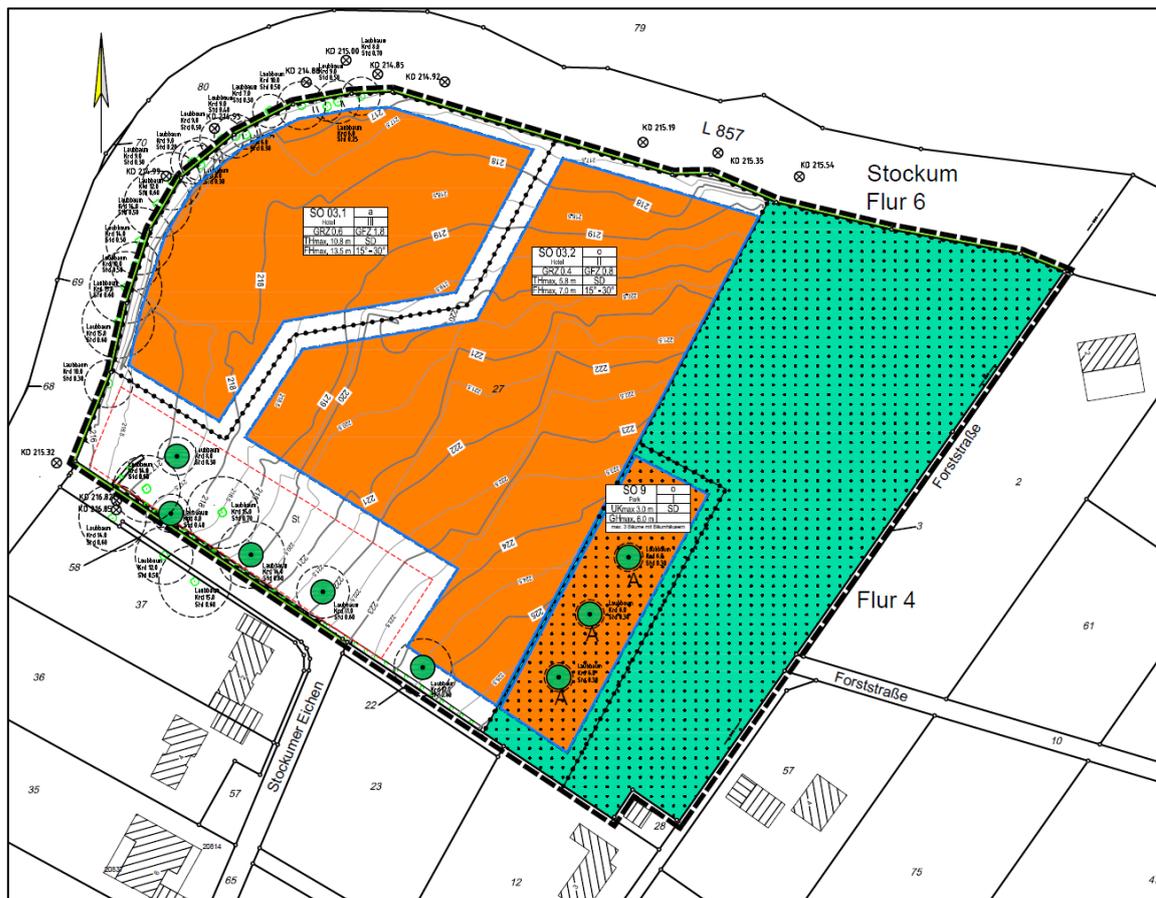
Bebauungsplan Nr. 4 -1. Änderung (Ludwig & Schwefer, 2024)
